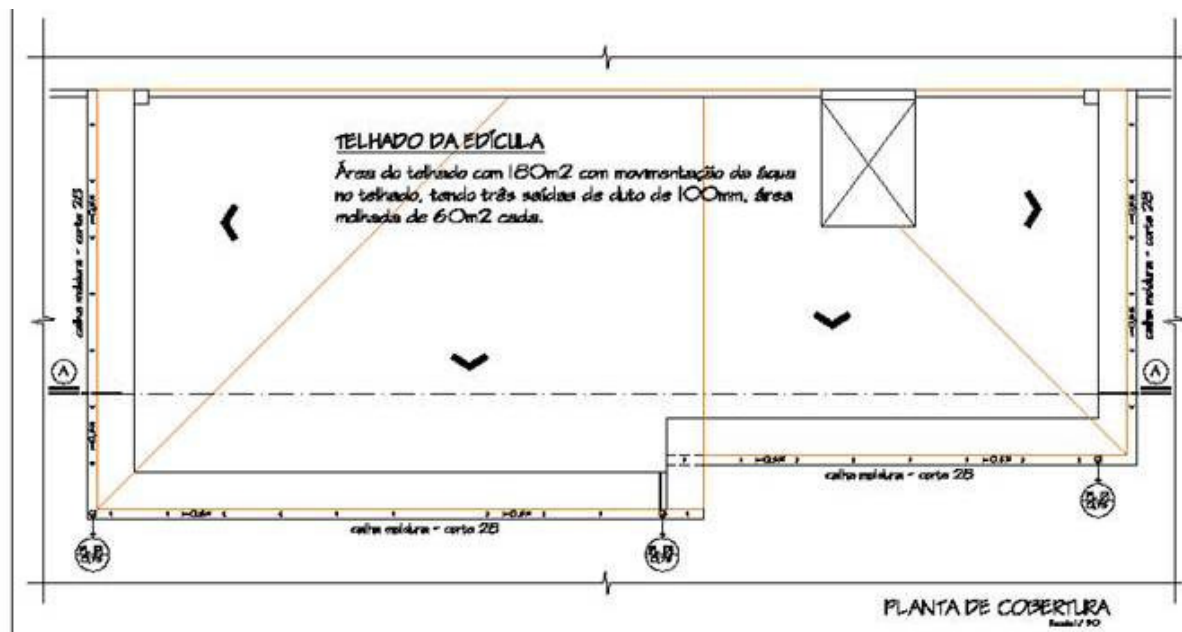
Planta situação/localização onde será instalado o sistema de captação de água de chuva, e eólico. Escala 1/200
